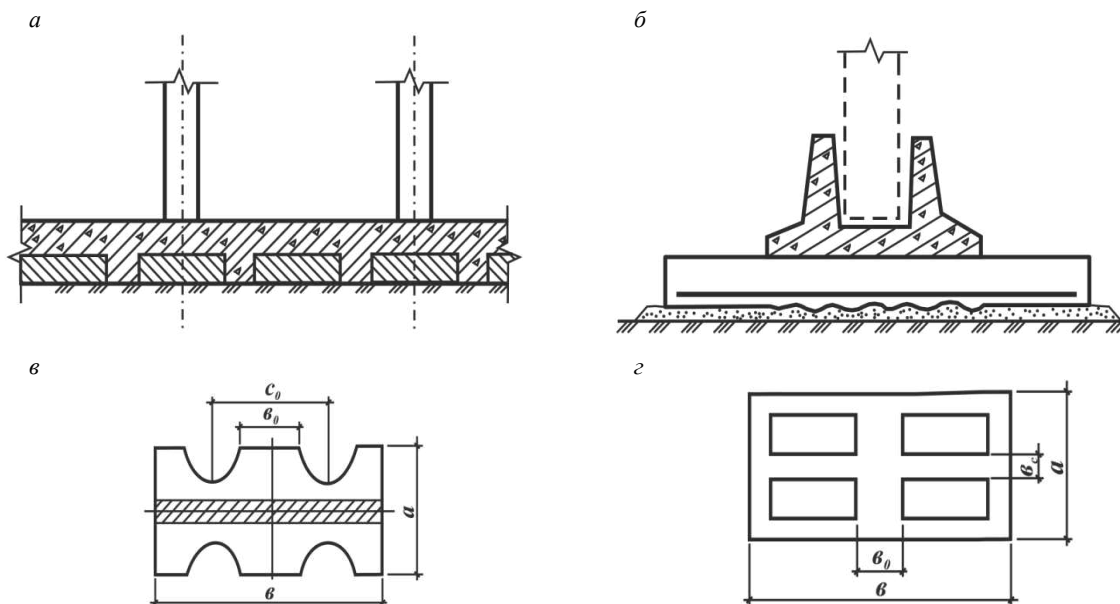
Деякі конструктивні рішення фундаментів, що мають елементами саморегулювання: *а* – фундамент із заповненням безопорних ділянок низько модульним матеріалом; *б* – фундамент із рифленою поверхнею в центральній частині; *в* – фундамент з вирізами на опорних консолях; *г* – решітчастий фундамент
